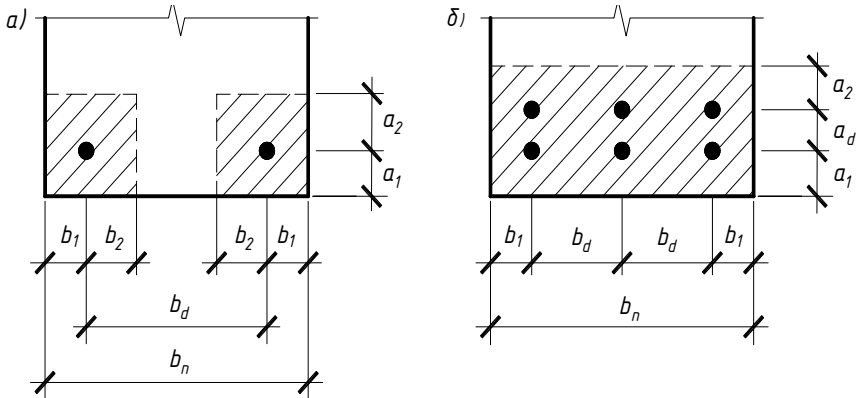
До розрахунку площі поперечного перерізу розтягнутого бетону в зоні активного зчеплення з арматурою для випадків: а) $b_d > 5 \cdot \varnothing_s$;
